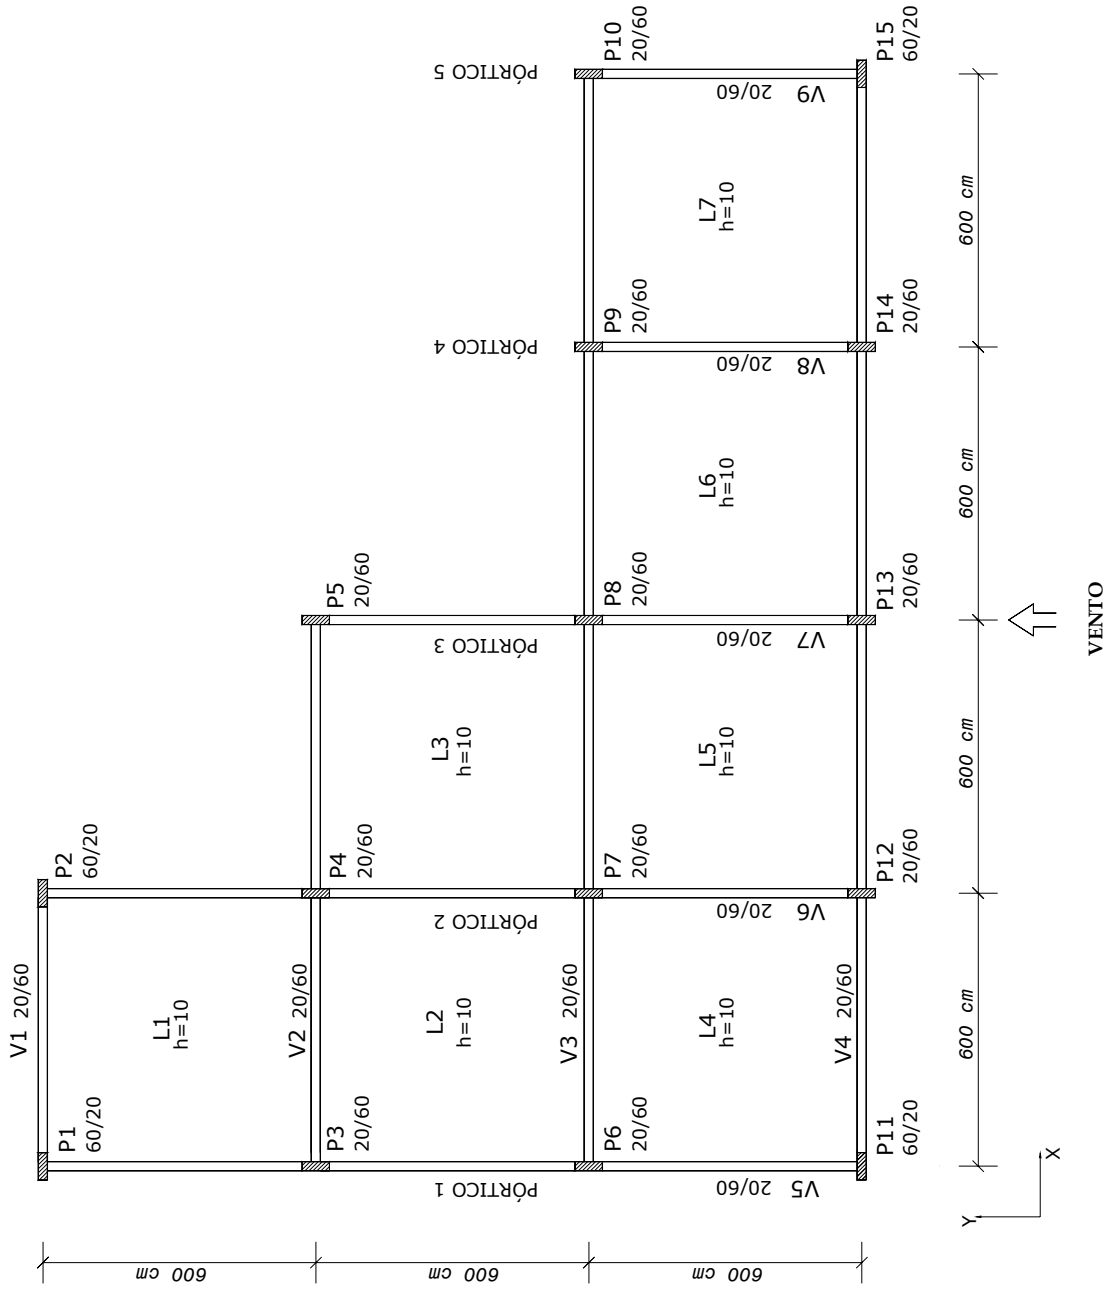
Forma do pavimento tipo da Estrutura 4.
